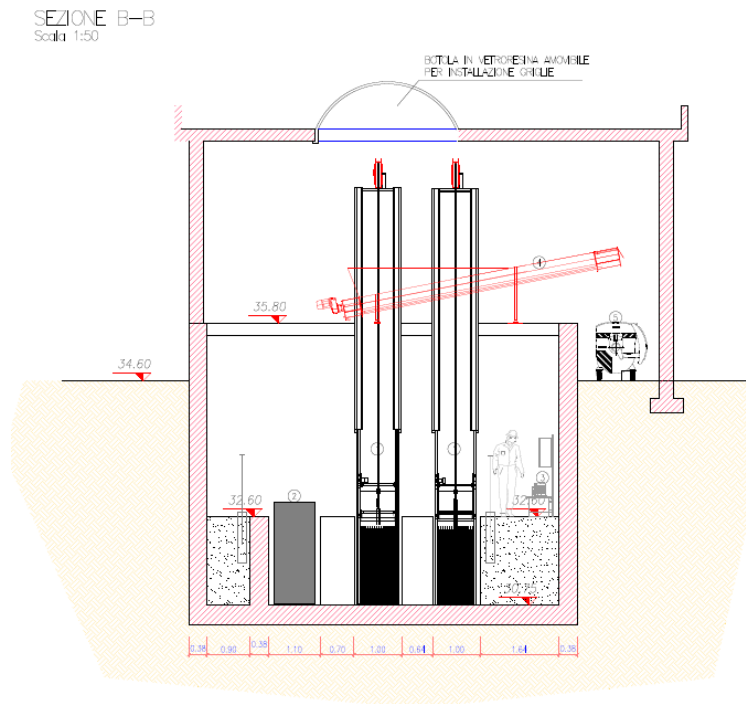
Pianta e sezioni nuovo edificio grigliatura grossolana
